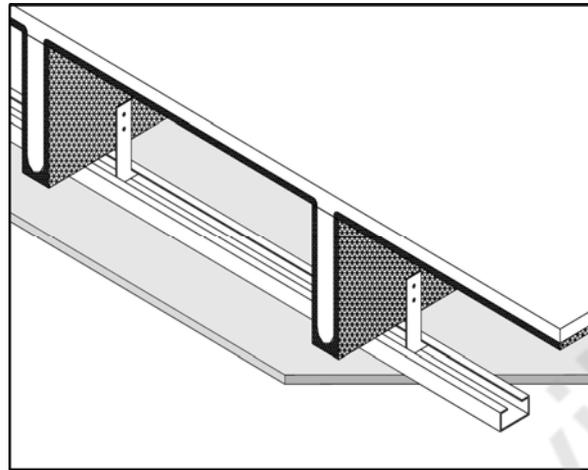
Plancher stable au feu 1/2h avec écran 1/4h
